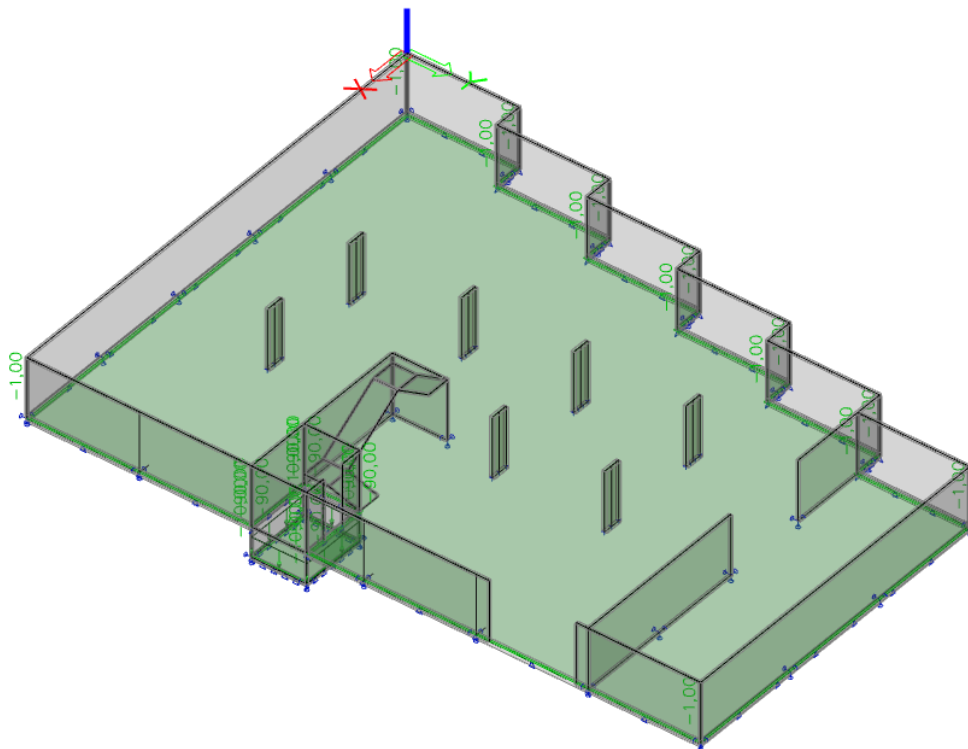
Schéma půdorysu 1.PP s rozmístěním pilot pod základovou deskou
